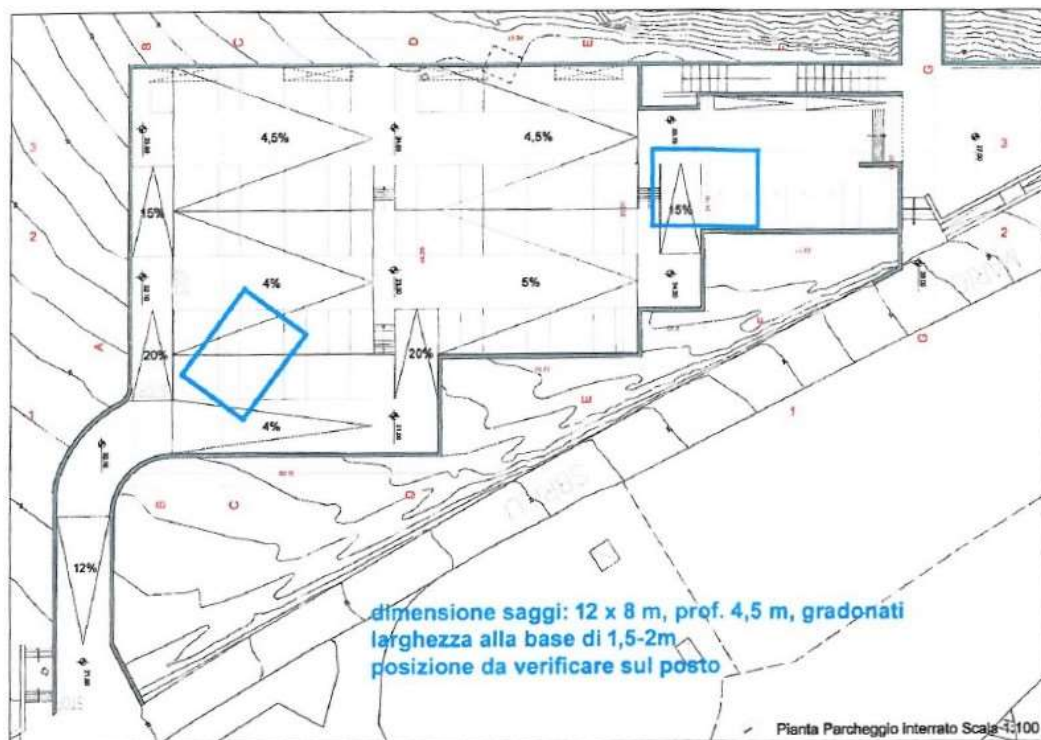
Planimetria del parcheggio sotterraneo con posizionamento dei saggi di accertamento indicati dalla SABAP
